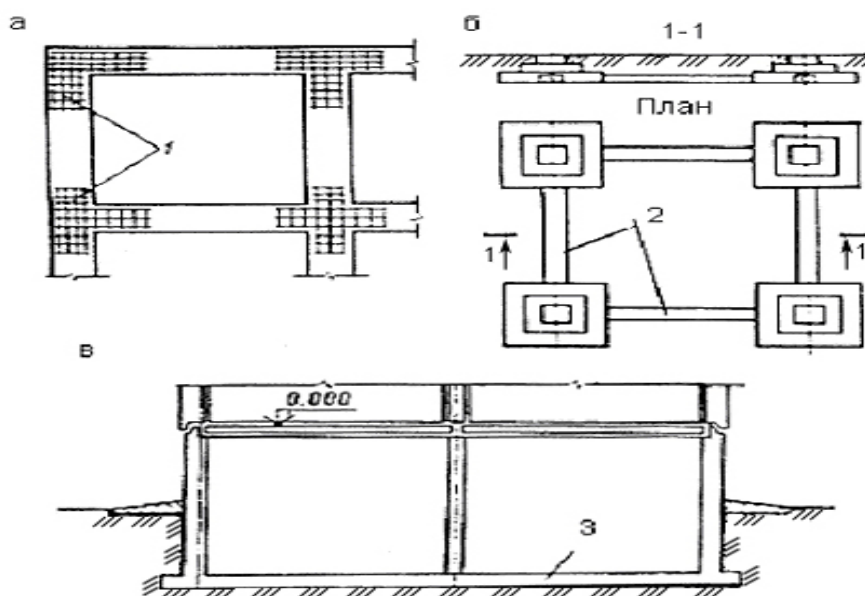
Конструкции фундаментов при сейсмических воздействиях: а - план ленточного фундамента; б – план и разрез столбчатых фундаментов; в – подвальная часть здания с плитным фундаментом; 1–арматурные сетки; 2 – фундаментная балка; 3 – плита из монолитного железобетона
